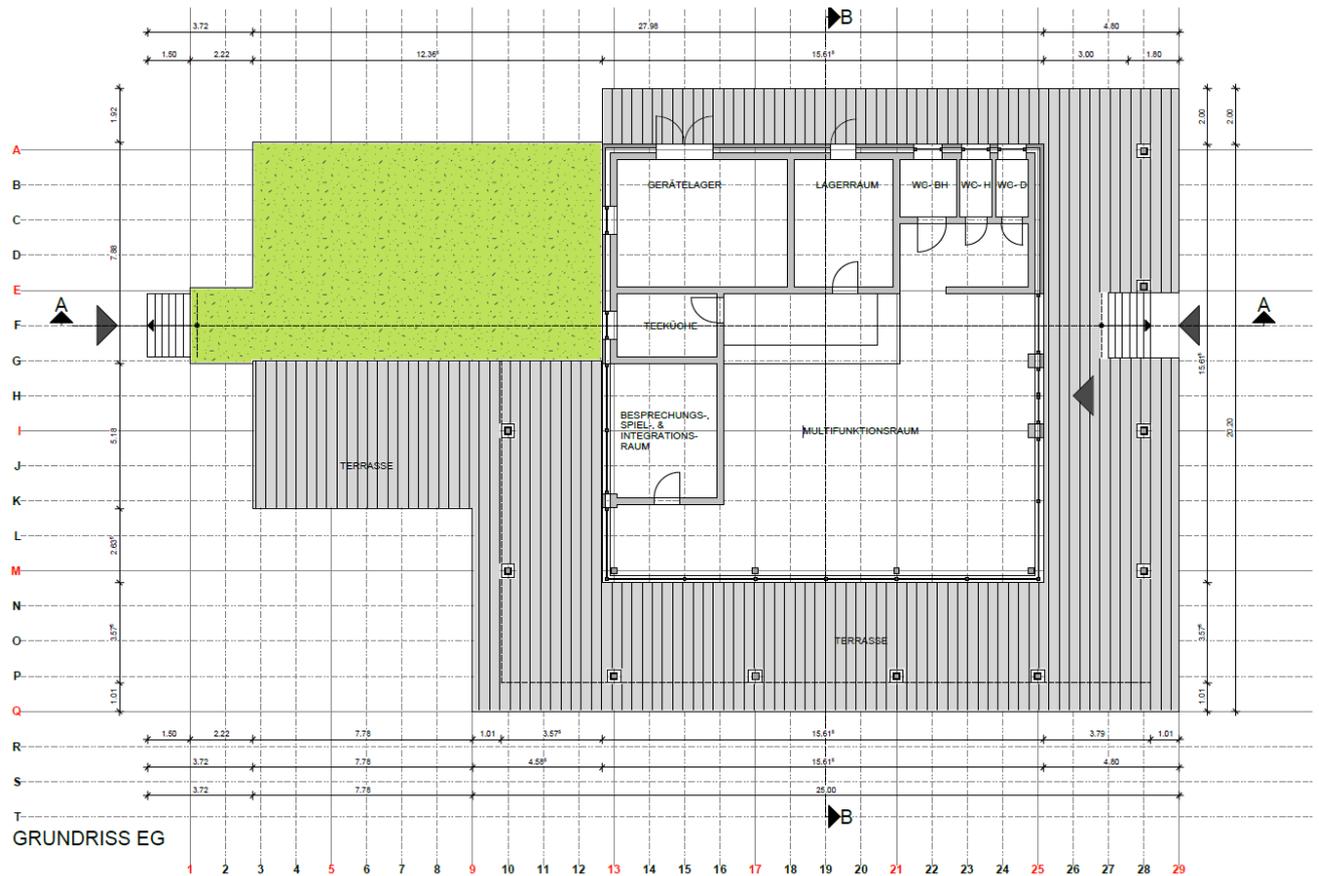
Planung Freizeittreff, Grundriss EG
